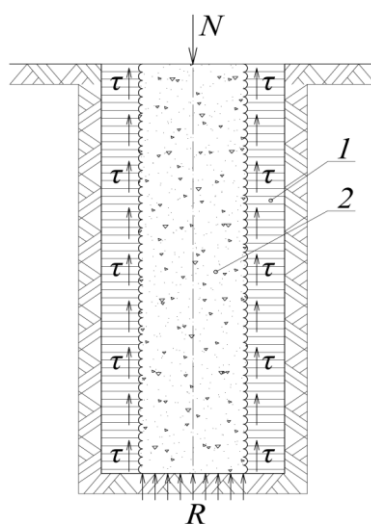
Схема к определению несущей способности сваи SFA (НПШ) по грунтоцементному основанию $Fd1$: 1 – грунтоцементный массив, 2 – свая SFA (НПШ).
